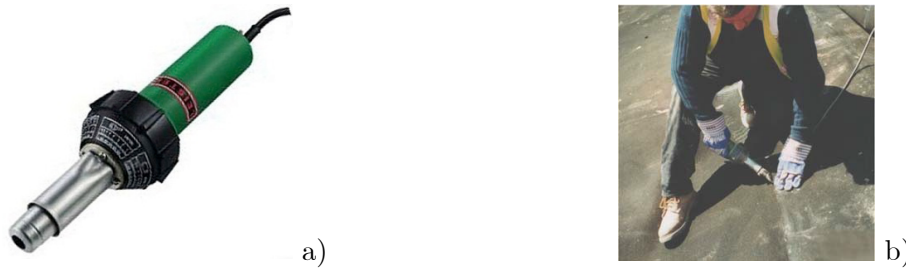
Soldadura com pistola de ar quente : a) pistola de ar quente; b) execução de soldadura (Neoplastic)
